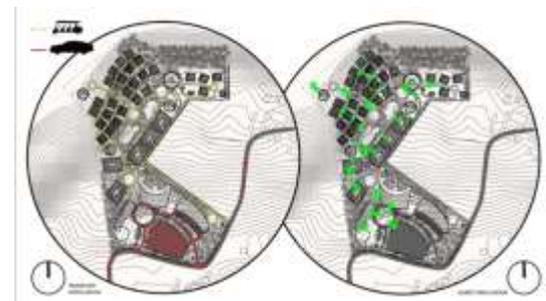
Site Plan. (Sumber : Ilustrasi Pribadi)
